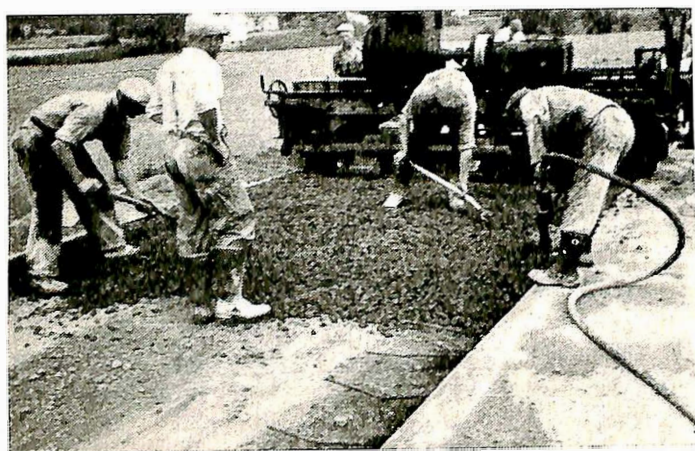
Til høyre kantvibrering med pressluftdrevet stavvibrator. I bakgrunnen vibreringsmaskinen.
